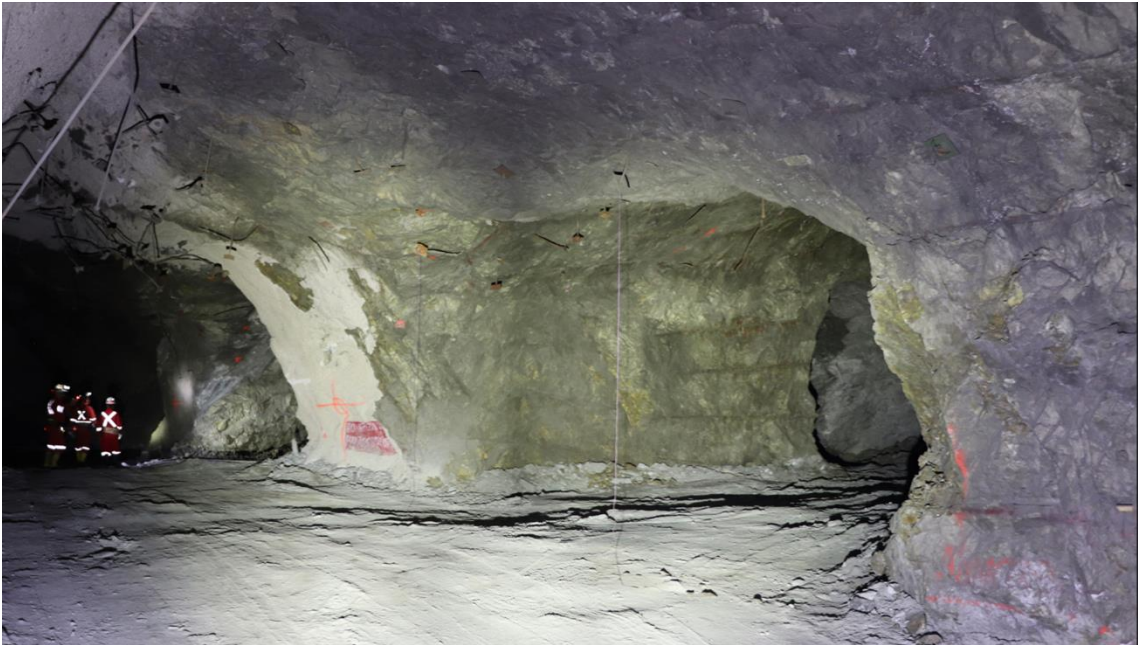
Rebaje explotado con el sistema de cuartos y pilares ascendente; los pilares están compuestos por sulfuro masivo. Cuando el mineral se encuentra fracturado es necesario aplicar concreto lanzado.
